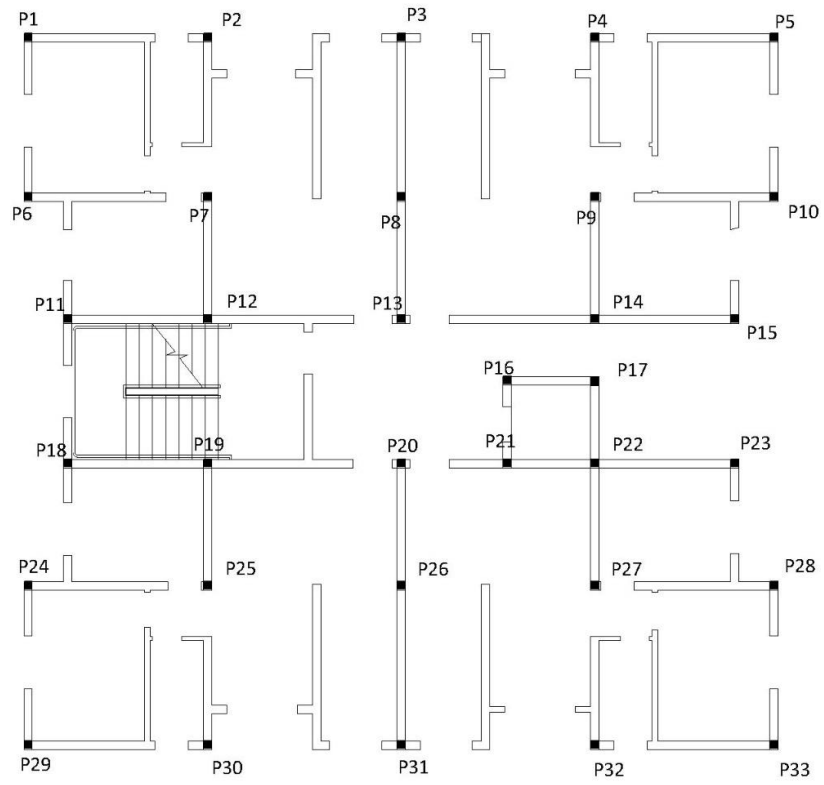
Locação dos pilares da segunda concepção estrutural (Fonte: autor próprio)
